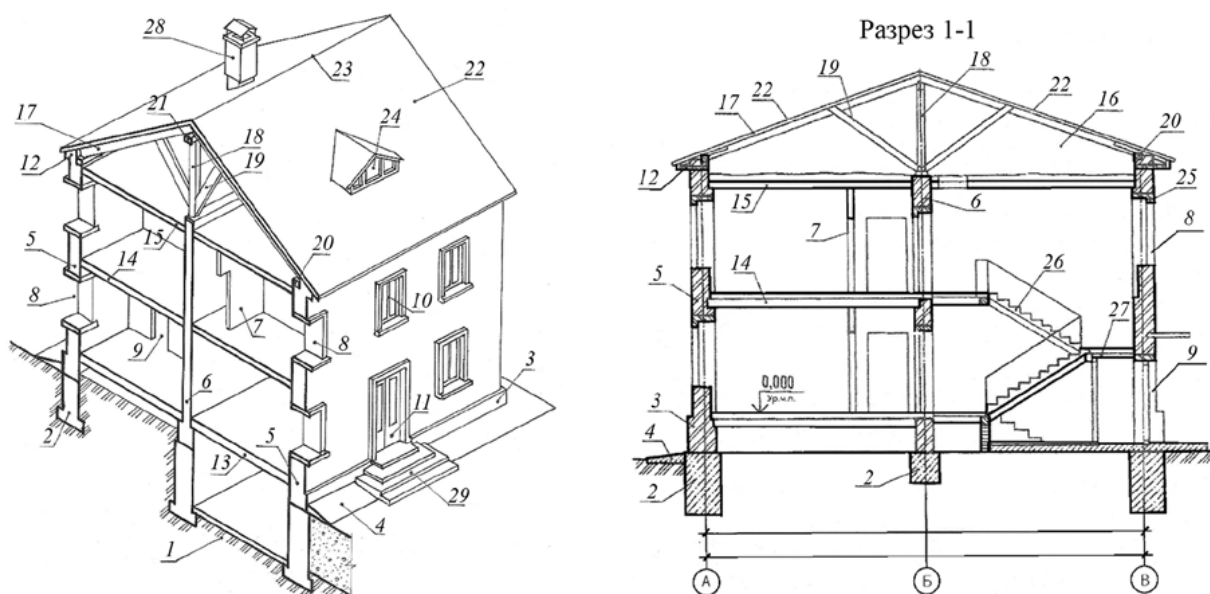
Основные конструктивные элементы здания с несущими стенами:
